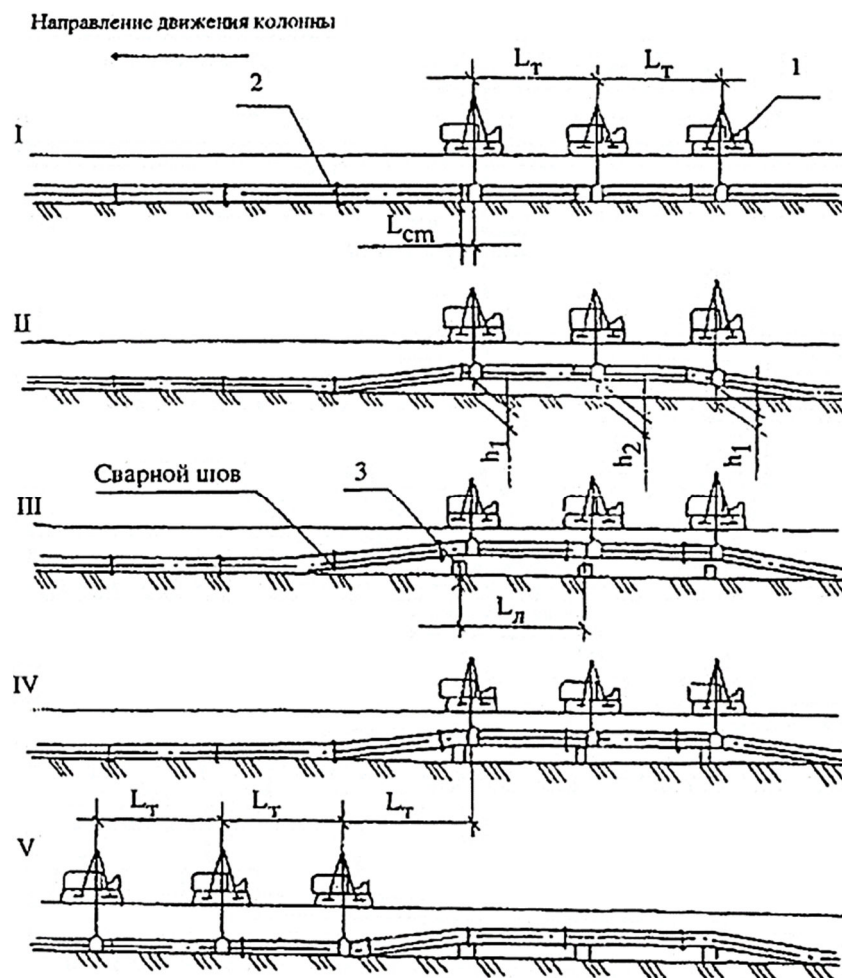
Схема подъема и укладки нефтепровода на лежки одновременно тремя трубоукладчиками: 1 – трубоукладчик; 2 – нефтепровод; 3 – лежка; L_T – расстояние между трубоукладчиками; L_L – расстояние между лежкам; L_{cm} – расстояние от места установки полотенца до поперечного сварного шва; h_1 – высота подъема под крайними трубоукладчиками; h_2 – высота подъема под средним трубоукладчиком
